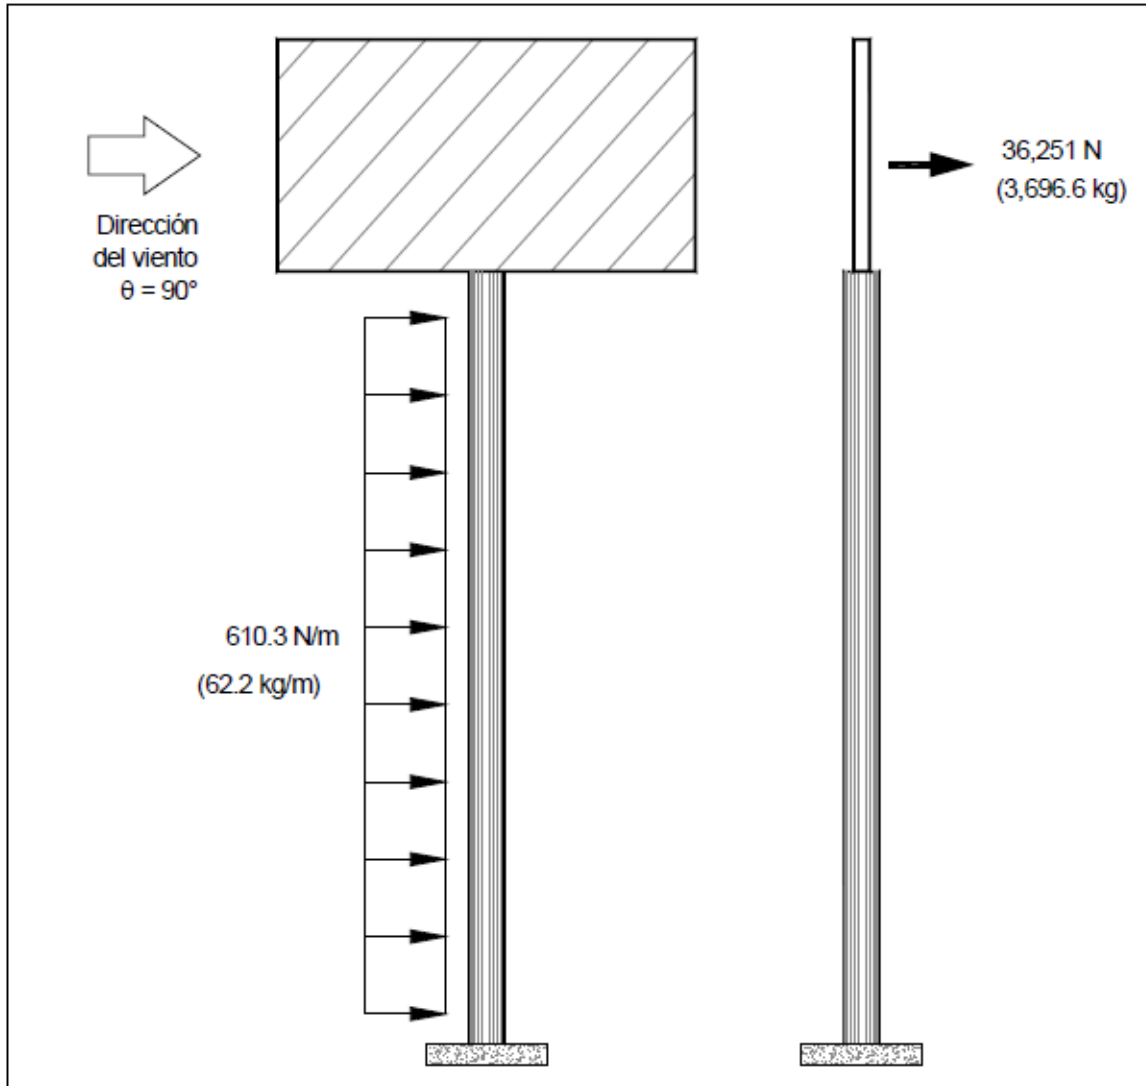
Fuerzas con viento paralelo al plano del espectacular.
